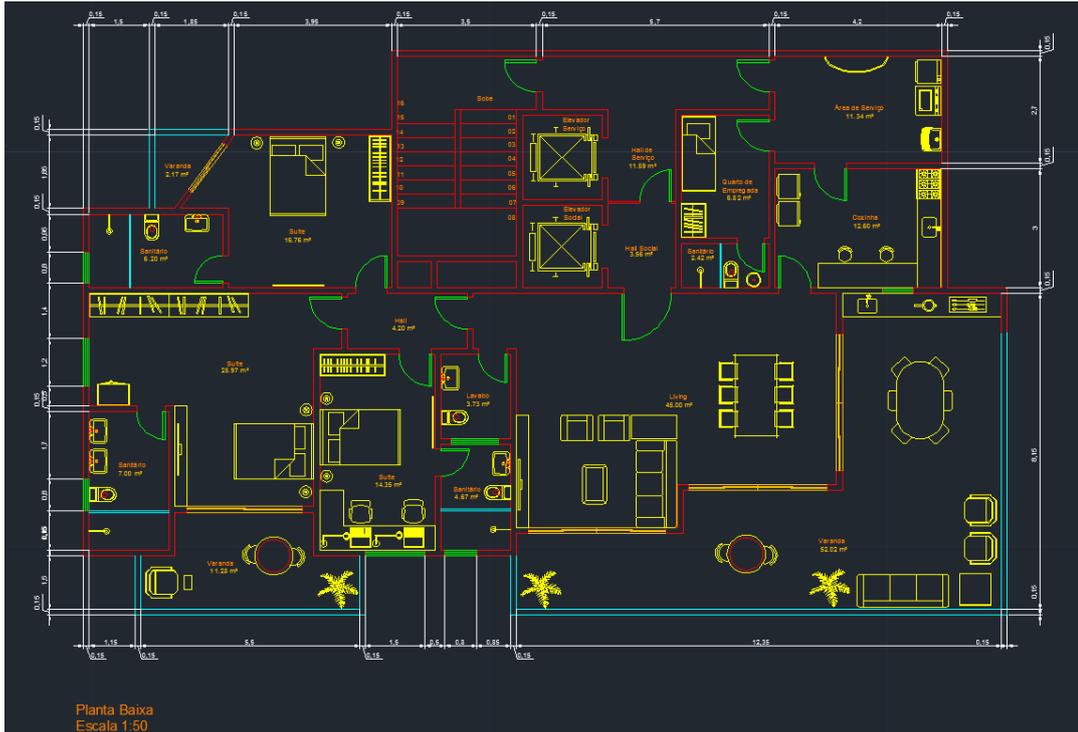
Imagem da planta baixa desenvolvida no Autocad.
